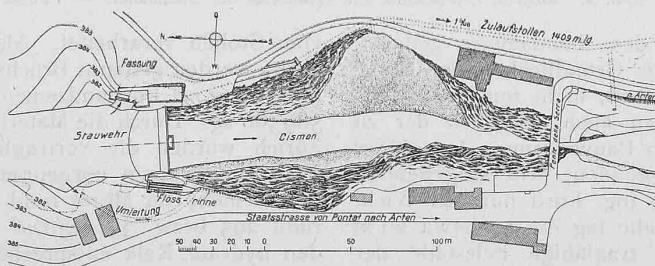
Lageplan der Wehrstelle. — Masstab 1:4000.
